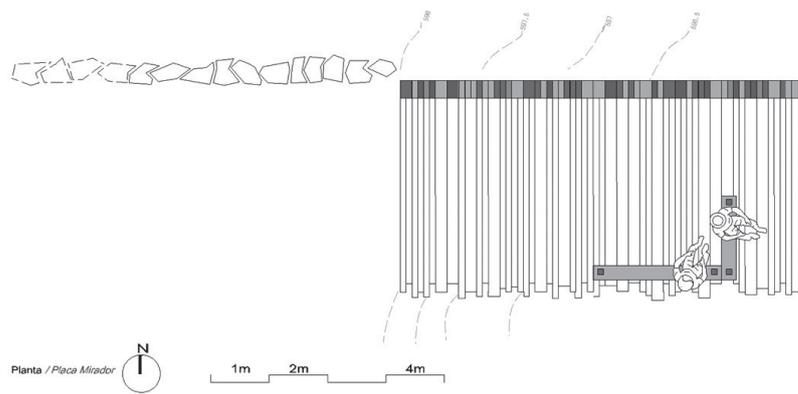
e 1.15 Planta e Corte Transversal do Placa Mirador. [Fontes: <http://www.archdaily.com>]
